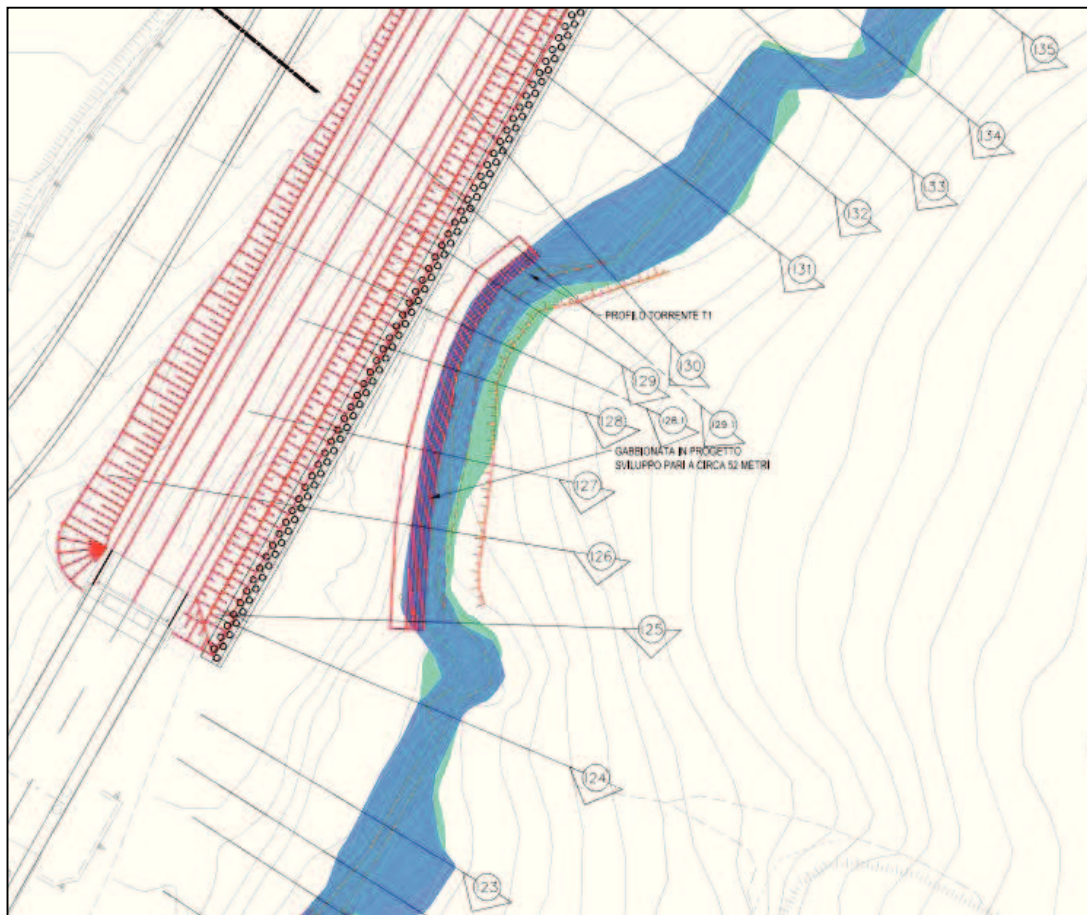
Stralcio planimetria aree esondabili torrente T1 in condizioni di stato di fatto e di progetto TR 100 anni – tratto di torrente più prossimo al rilevato stradale della S.S. 121 in cui sarà realizzata la gabbionata in progetto.
